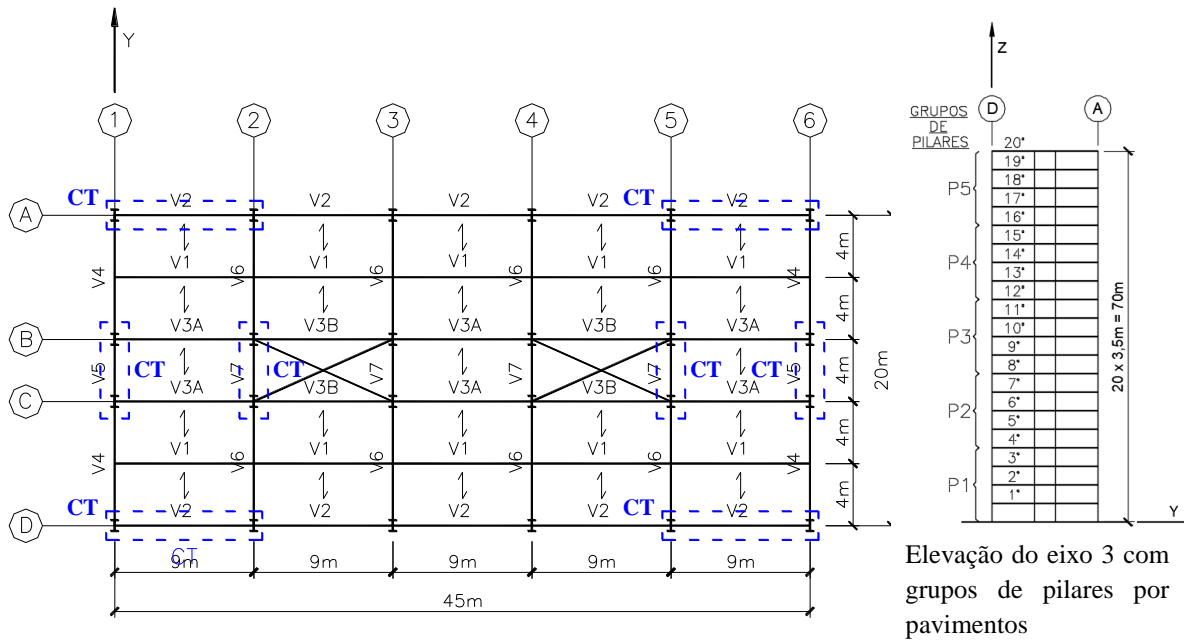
Pavimento tipo do edifício modelo e grupos de pilares. (Fonte: Baseado em Sáles [1])
